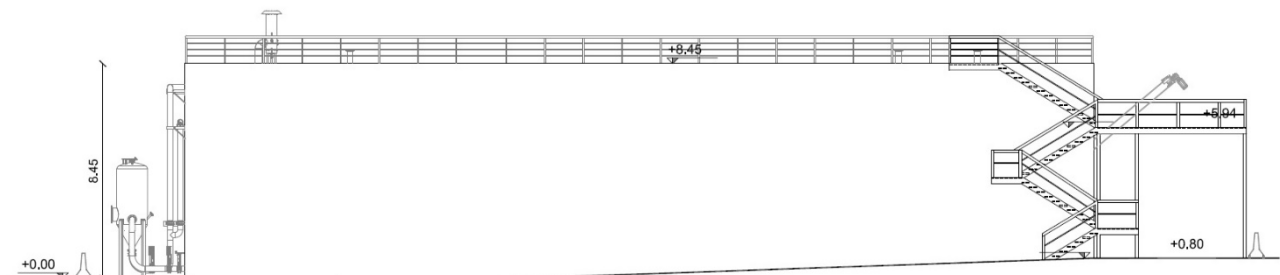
Prospetto della sezione di Digestione Anaerobica
